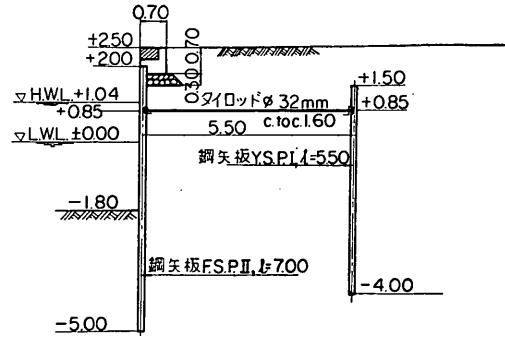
函館港湾町木材整理場北側 -1.8 m 護岸 (y-10) 標準断面図
